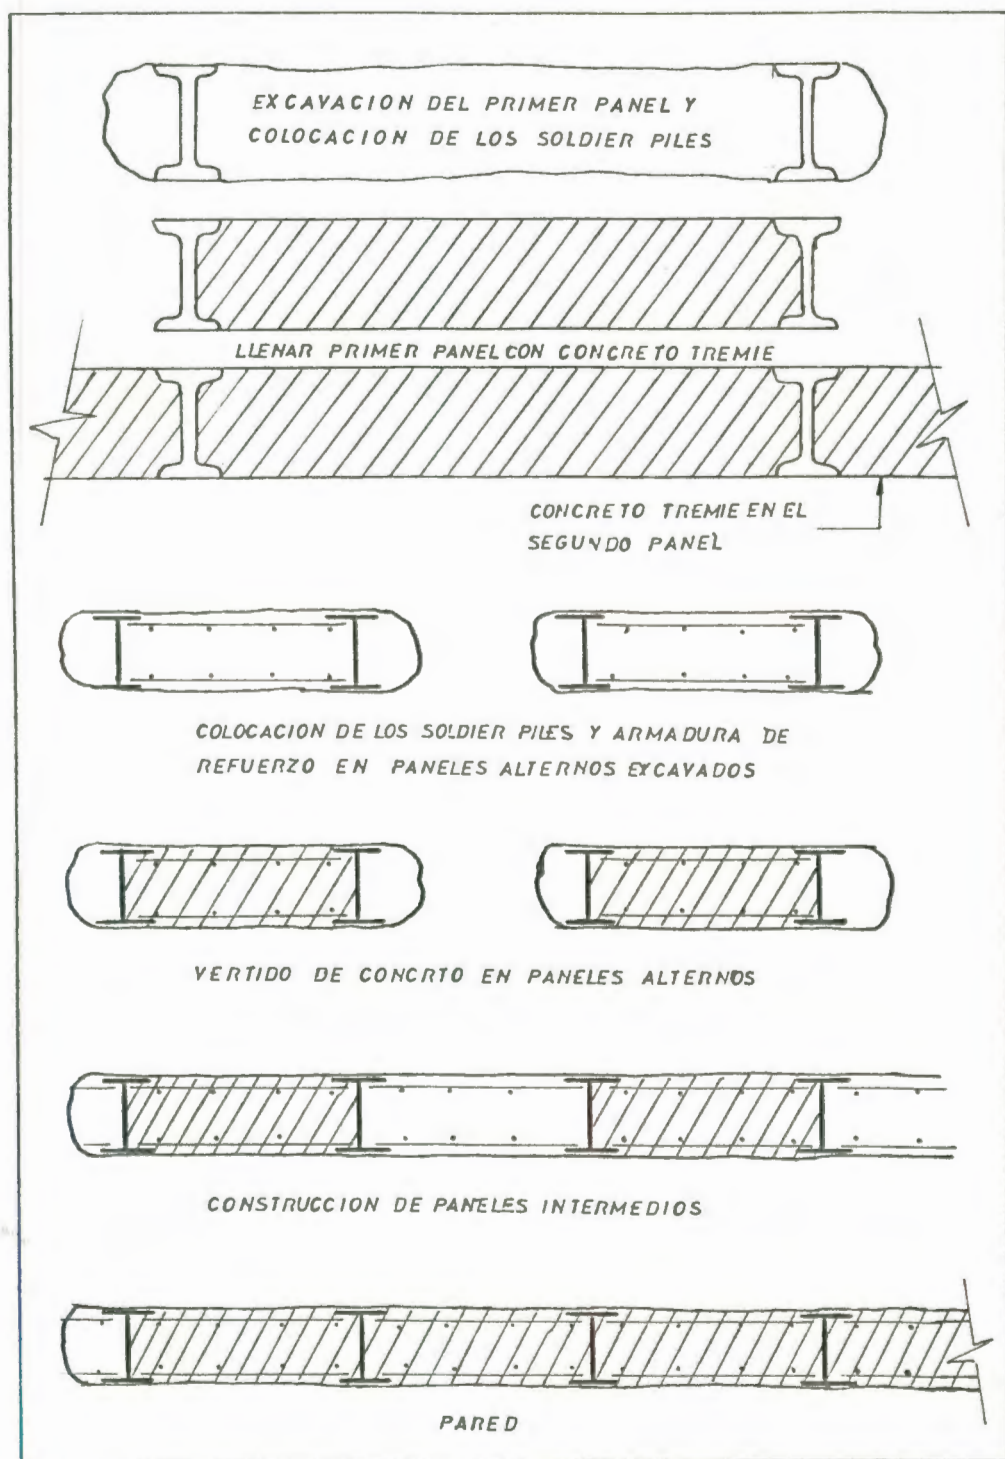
Excavación en una etapa, secuencia constructiva de la pared o muro vertical.
